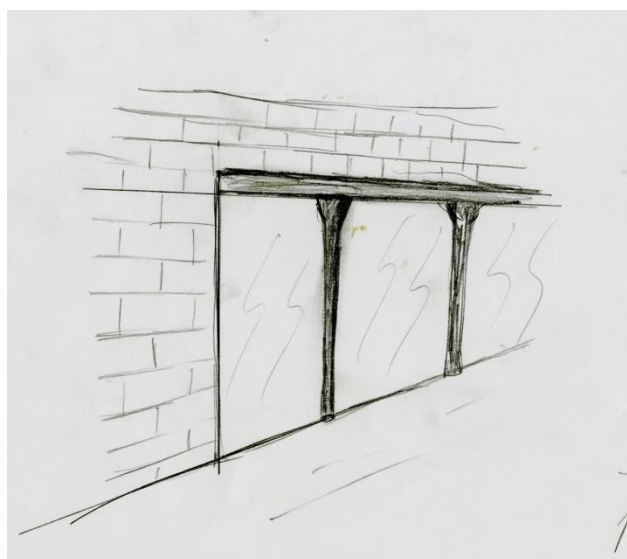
Croquis du linteau et des poteaux (Haouy)
